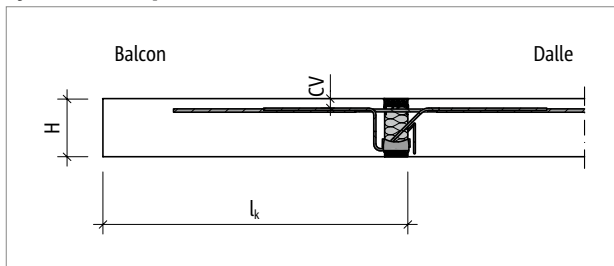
Schöck Isokorb® T Type K-E, K-T : Système statique, coupe
